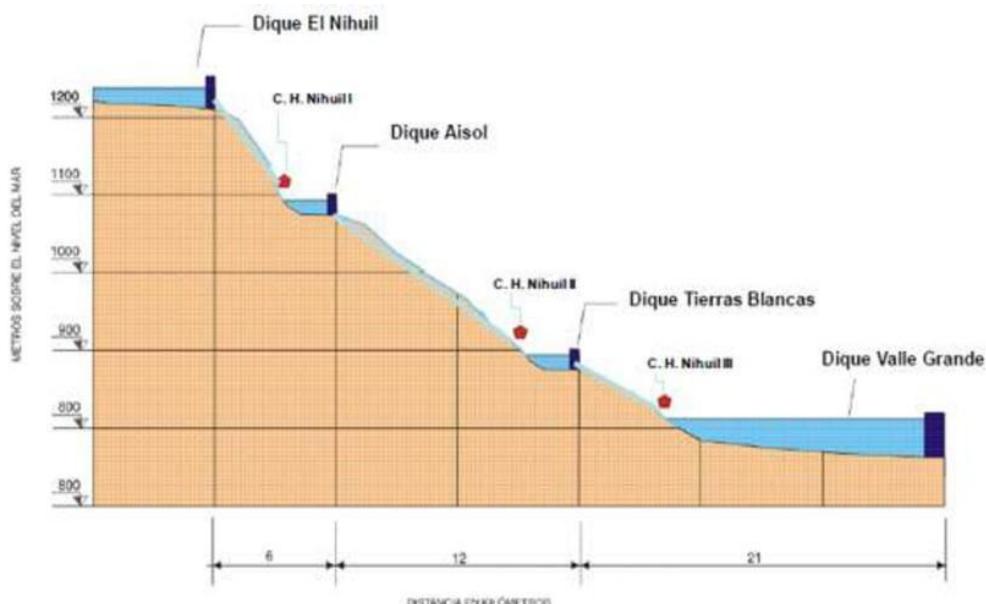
Perfil longitudinal SHE Los Nihuiles
